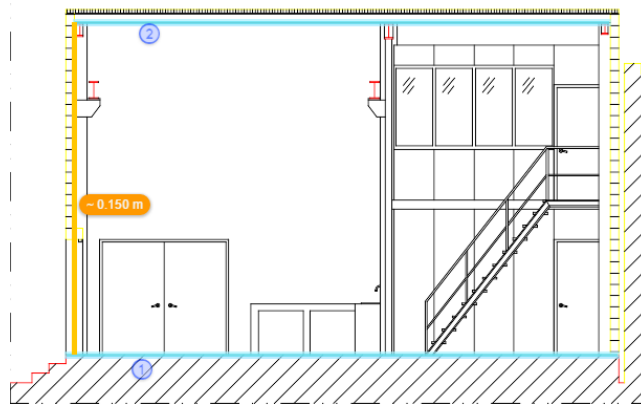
Altura del punto más bajo en la Planta Piloto de la Facultad de Ciencias
